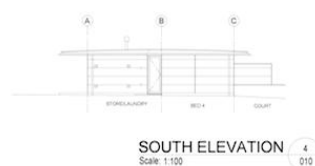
Pátio central / Plantas / Vista do exterior / Processo Construtivo - Compactação
